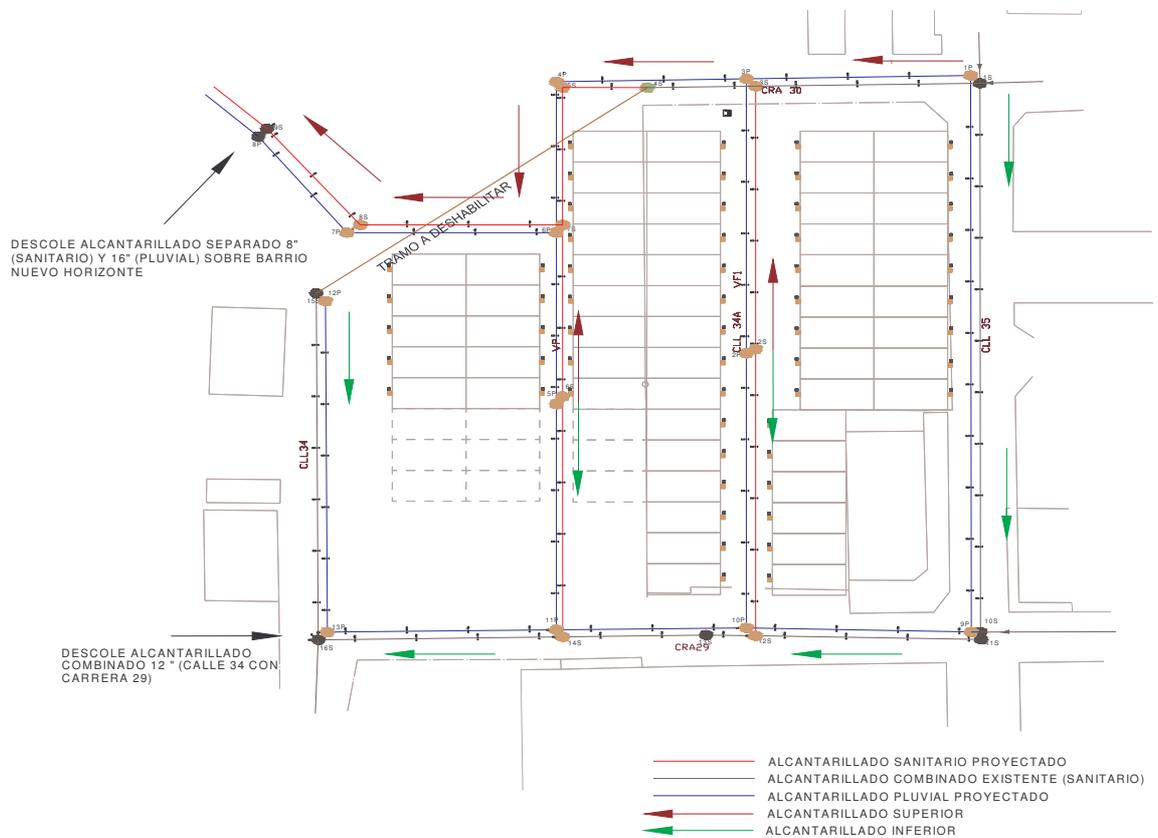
ALTERNATIVAS DE TRAZADO ALCANTARILLADO SEPARADO.
